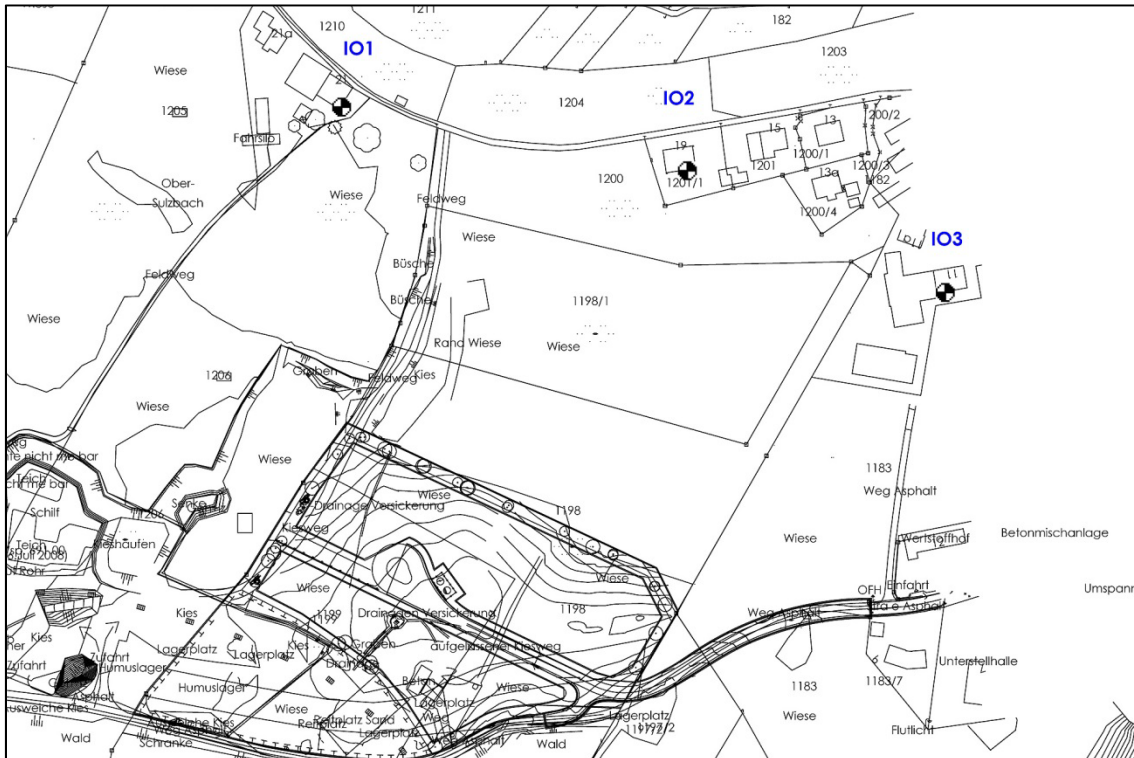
Lageplan mit Eintragung der maßgeblichen Immissionsorte IO
